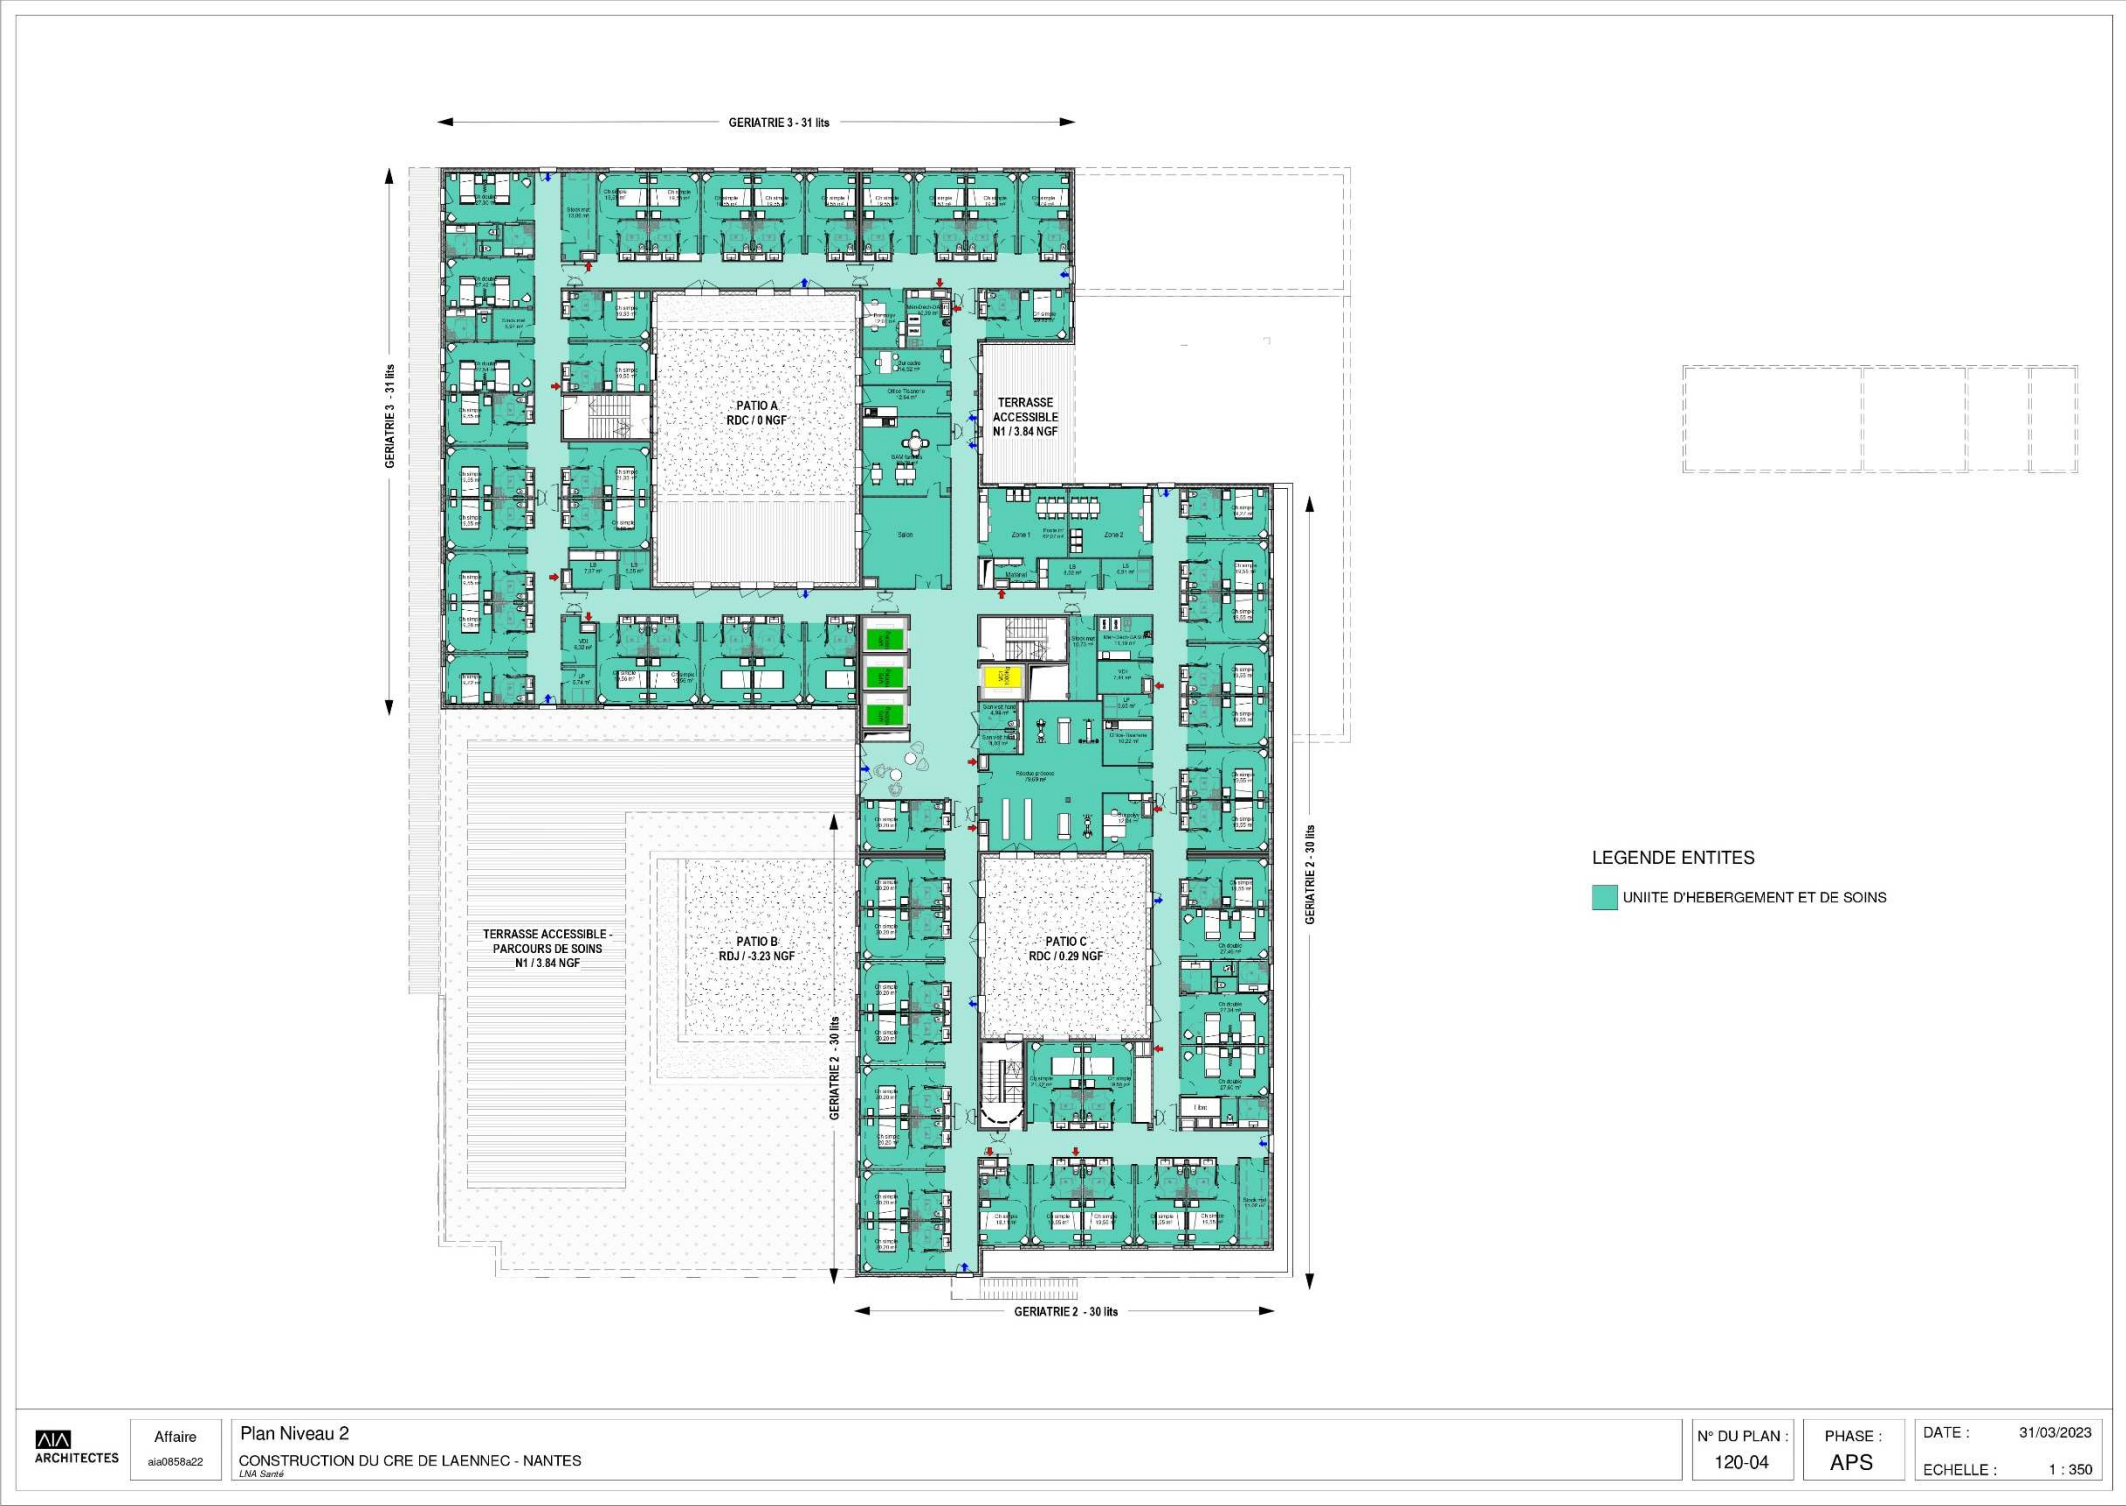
Plan de Niveau 2 (source: AIA Architectes, 31/03/2023)
